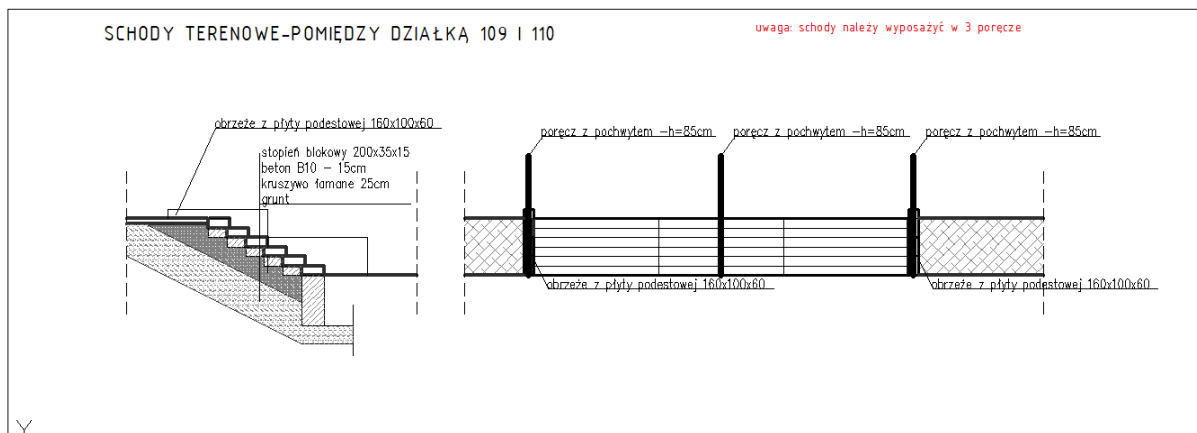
Proj. schody terenowe przy elewacji wschodniej budynku głównego.
